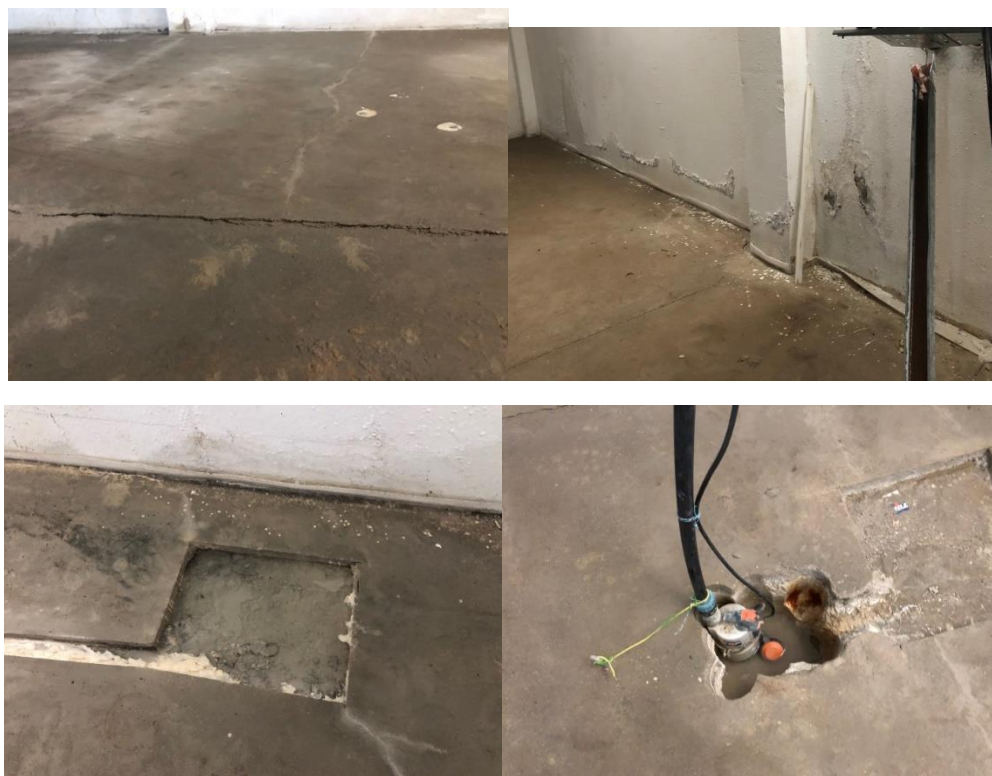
Трещины в конструкции пола подвала; увлажнение фактурного слоя стен подвала; дренажные каналы в стяжке и окна в фундаментной плите для откачки фильтрующейся воды
